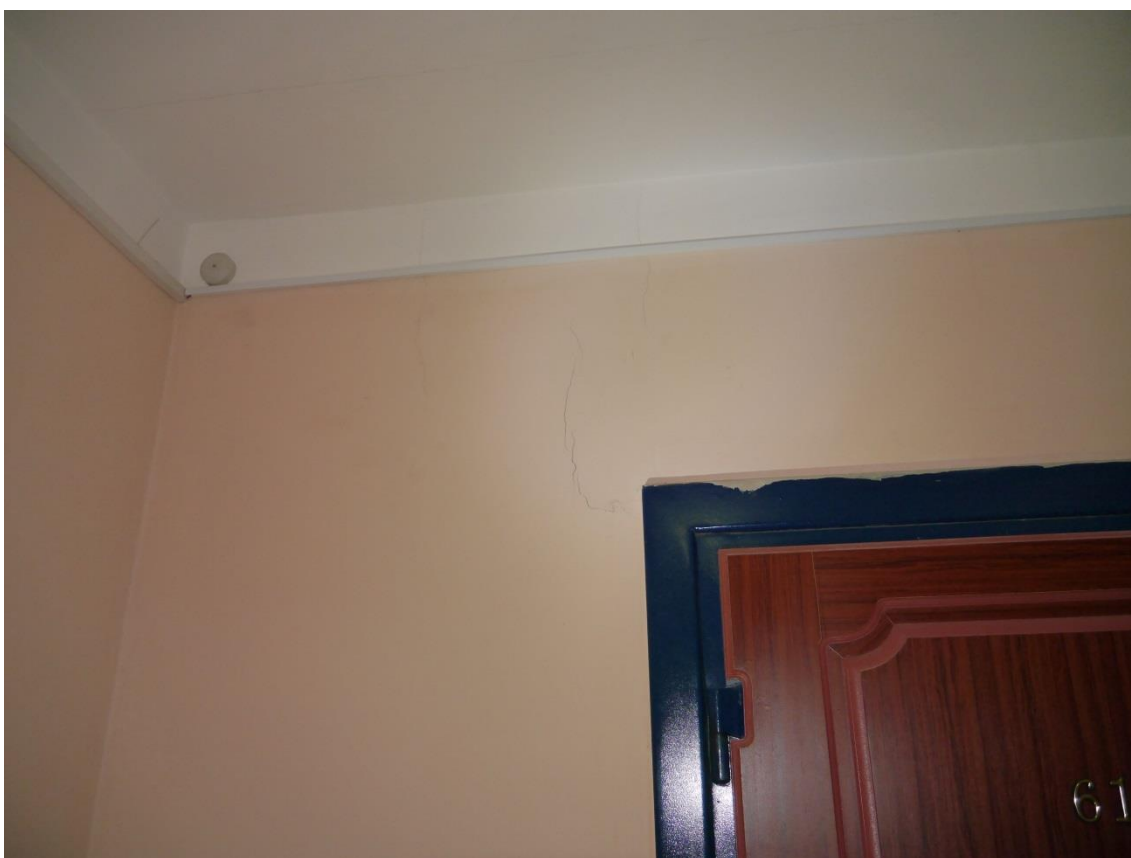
Трещина от угла дверного проема в смежной поперечной стене, в осях М-П/15, в уровне 10-го этажа.
